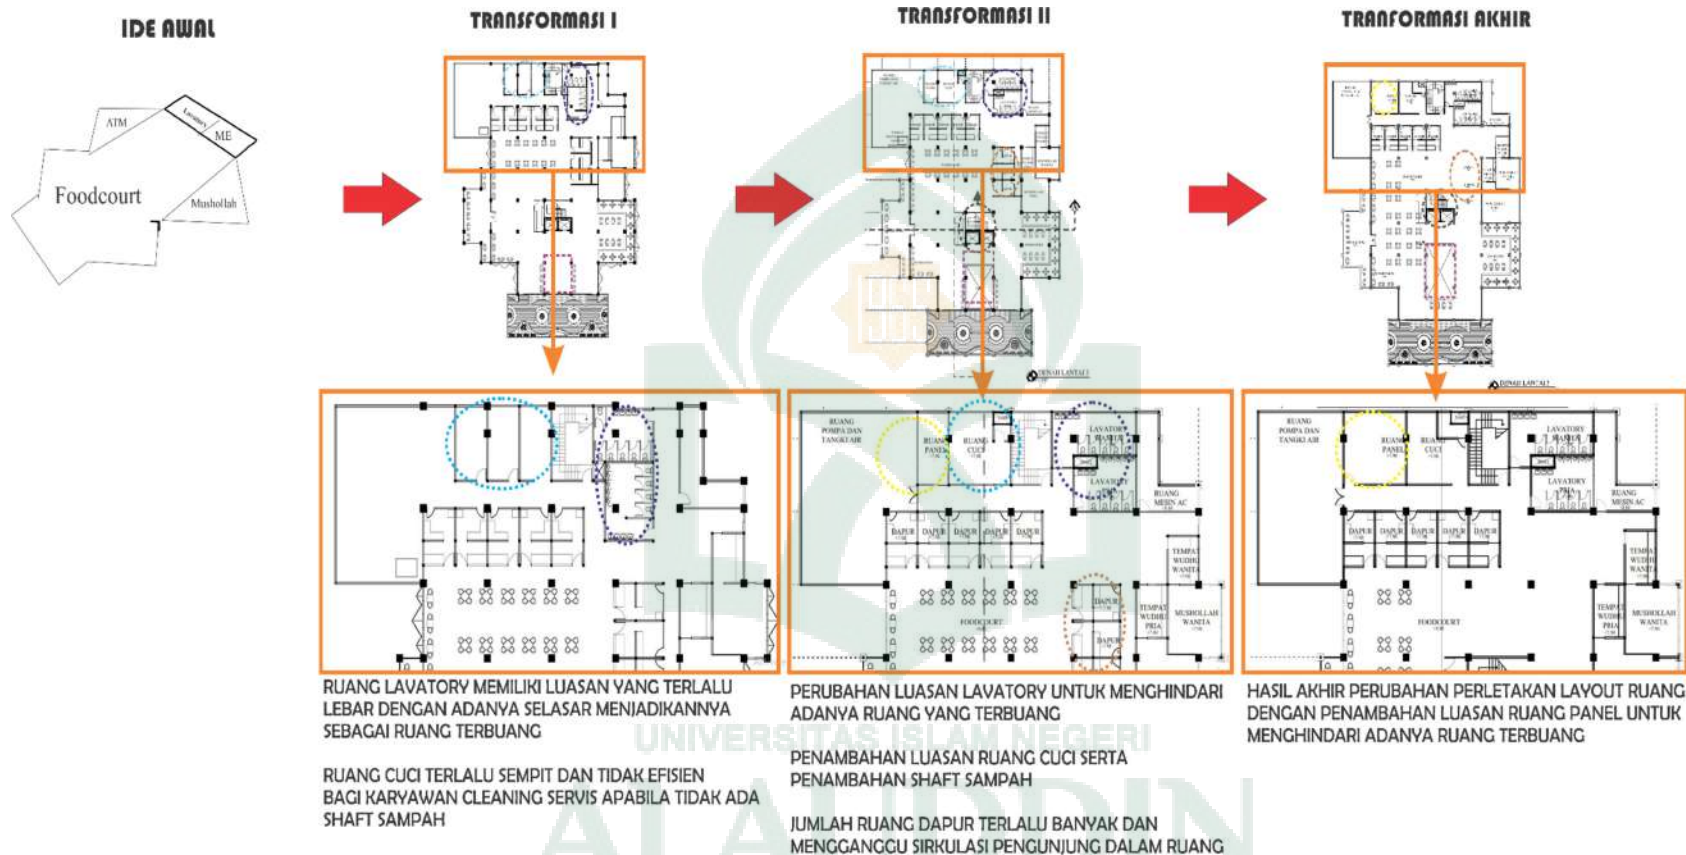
Transformasi Perletakan Layout Ruang Lantai 3 Perubahan 1
